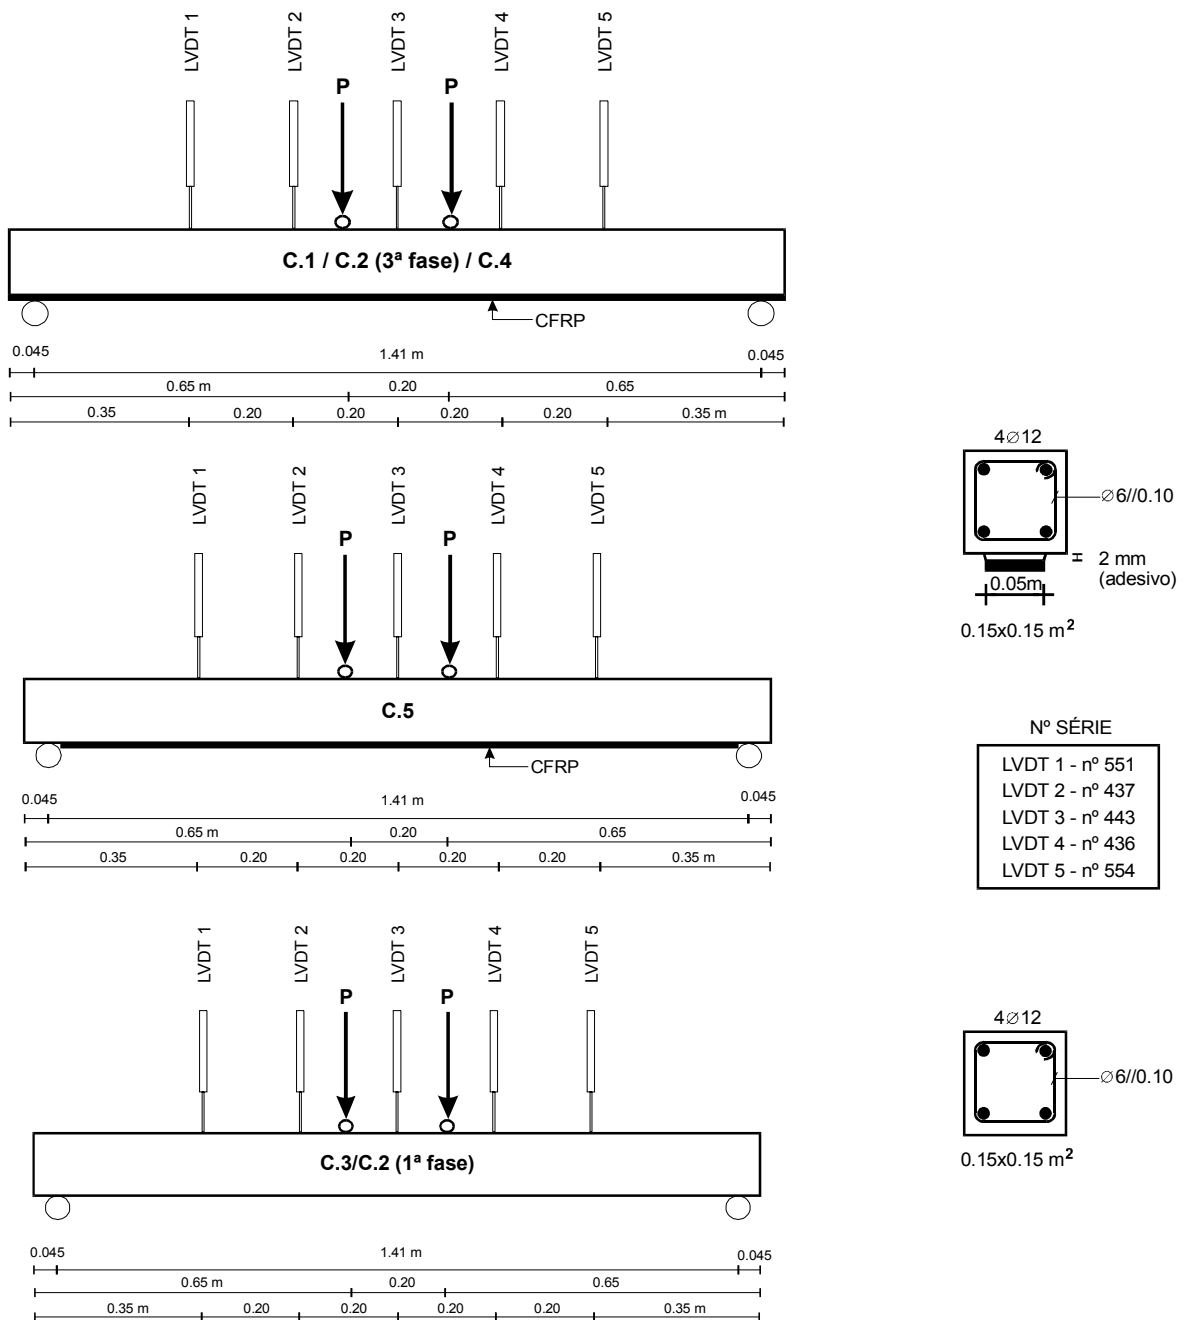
Geometria, armadura e instrumentação dos modelos de vigas tipo C.
